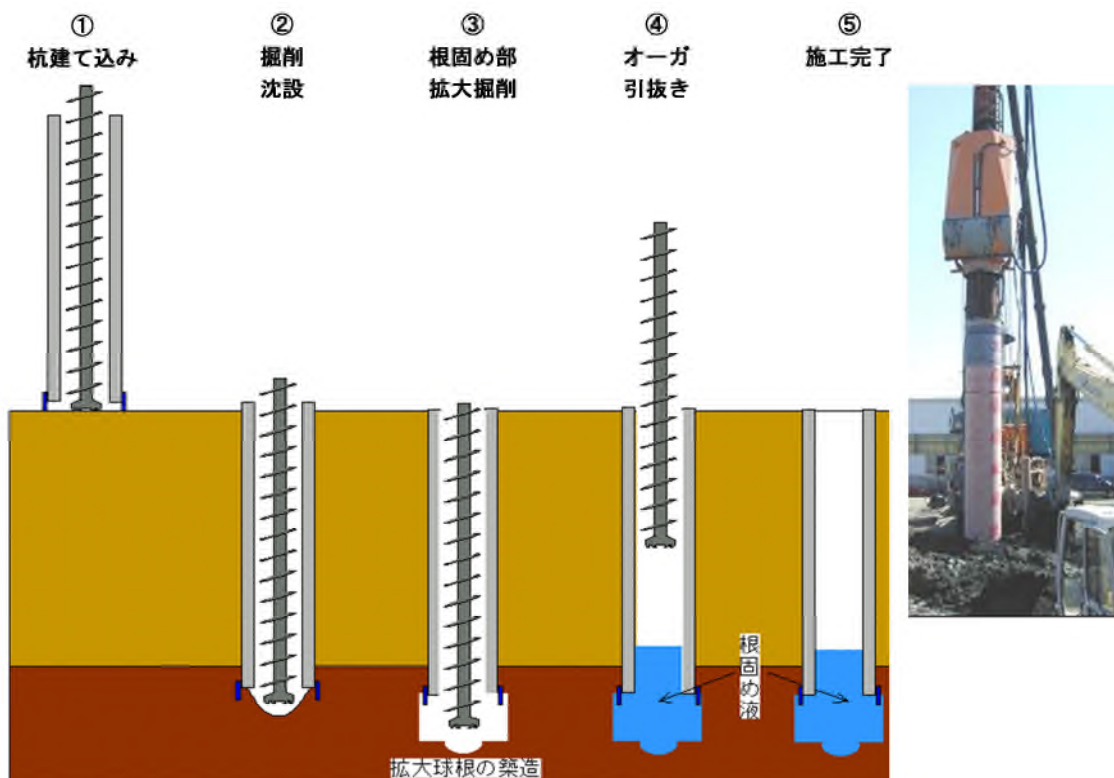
中掘り拡大根固め工法の施工手順と施工機械
